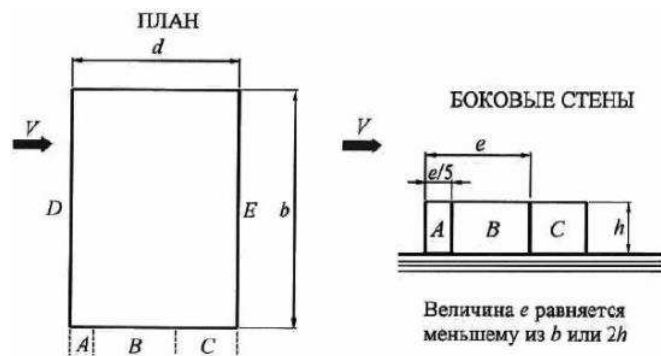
Схема приложения ветровой нагрузки на стены
